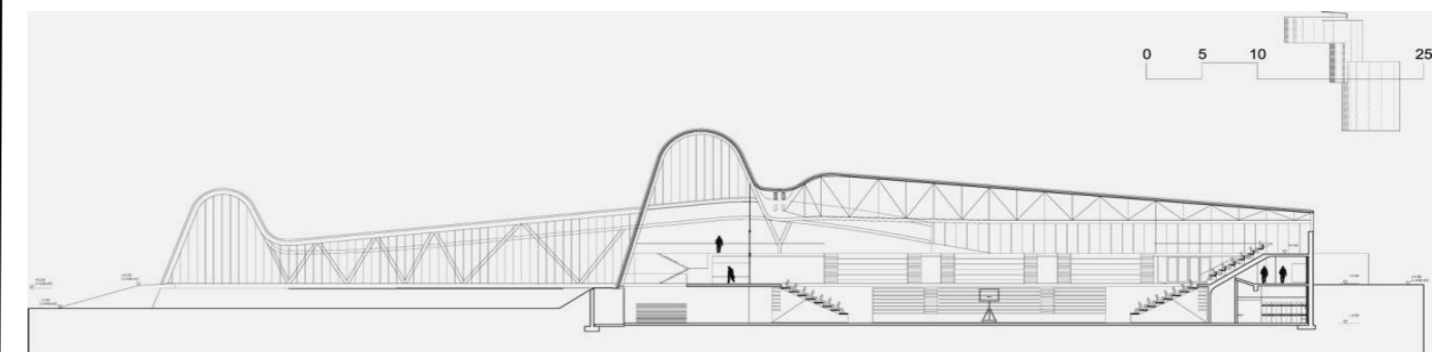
plan de coupe (salle polyvalente sport + concert) ACXT Langreo ⁽¹¹⁷⁾
